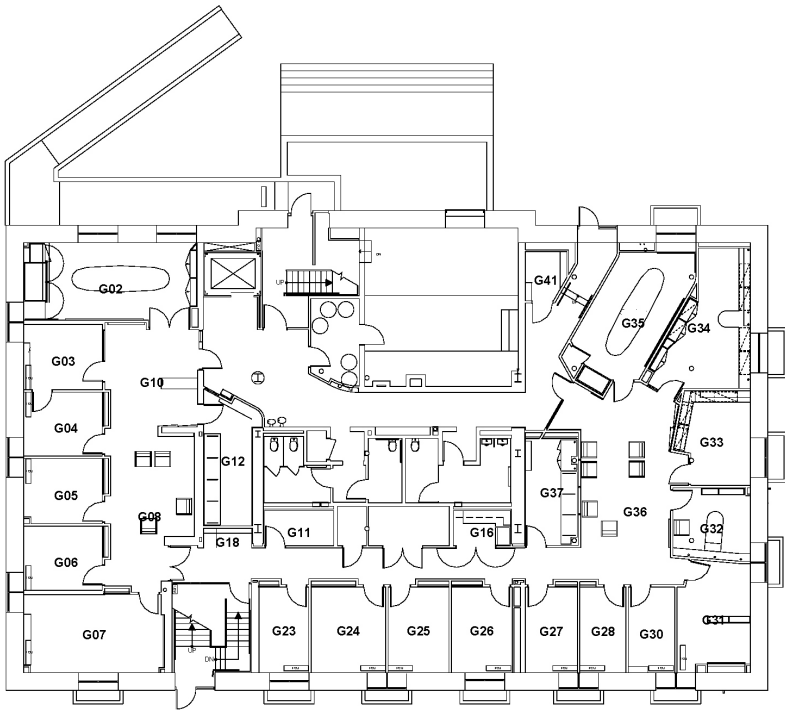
Cambridge (MA), Harvard University, Boylston Hall, Untergeschoß (1998): Grundriss
